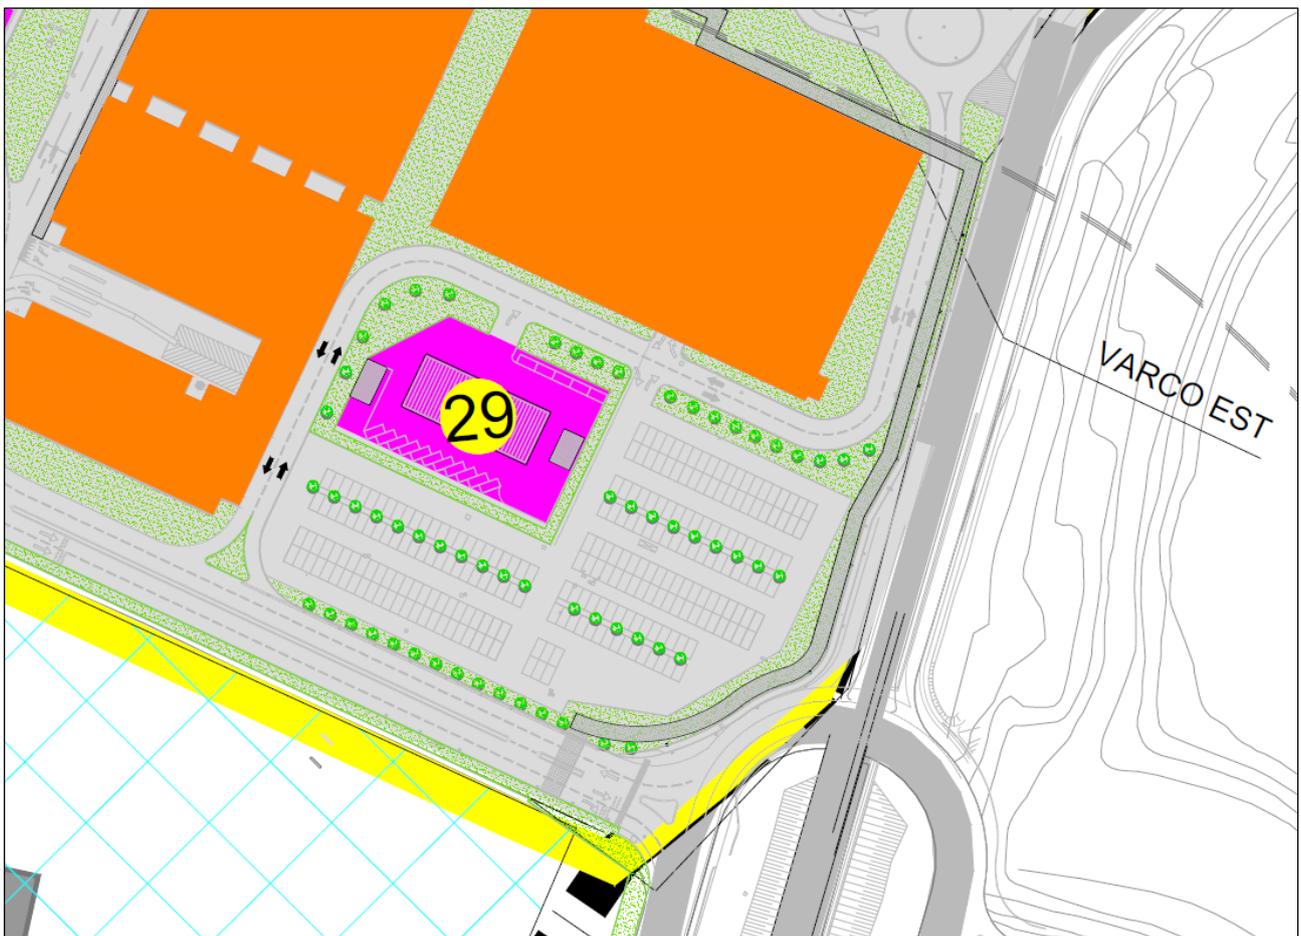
Estratto Master Plan – Stazione di servizio rifornimento carburanti e autolavaggio
